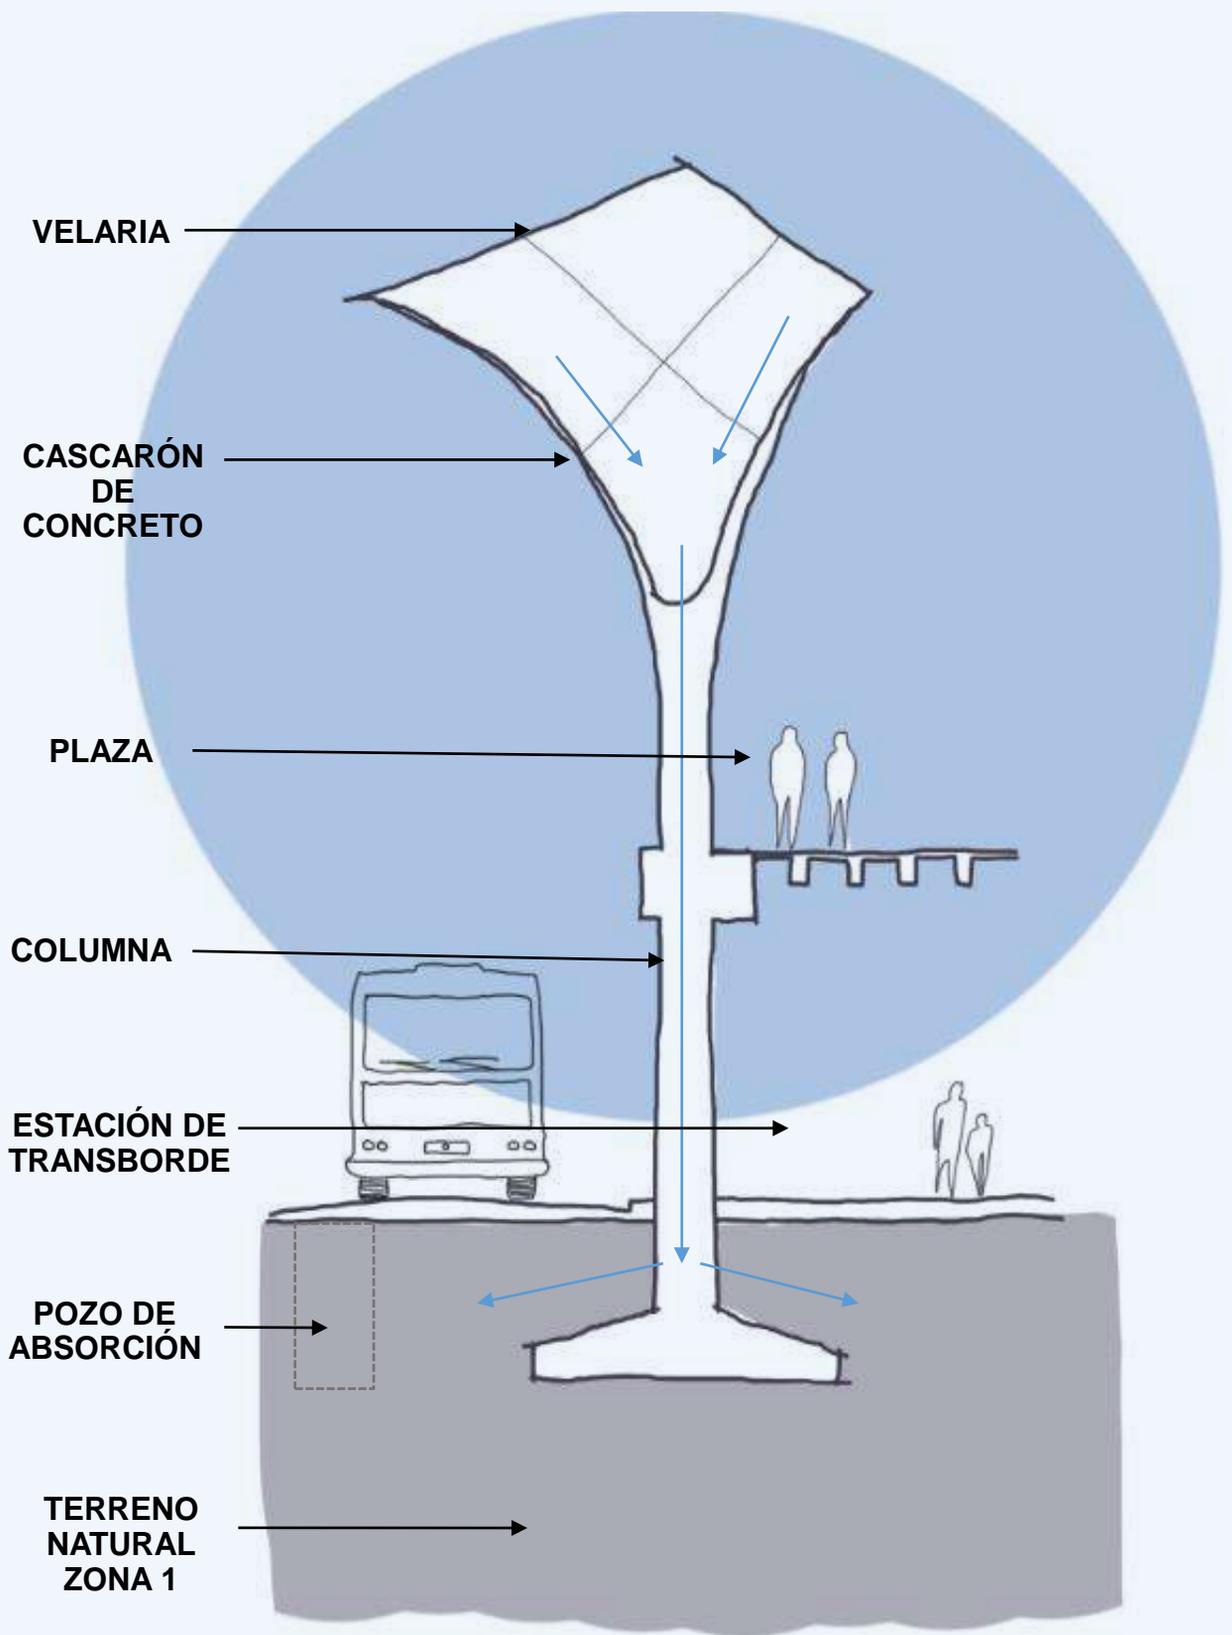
Esquema de columna y cubierta con captación de agua pluvial y proceso de permeabilidad.
